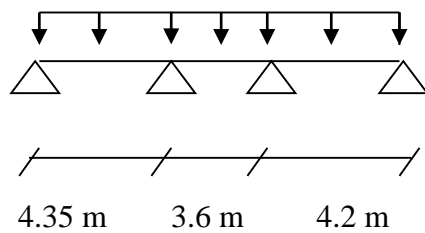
schéma statique de la poutre du 3^{ème} cas
